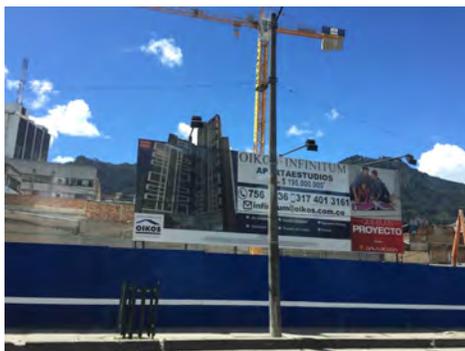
Proyecto de vivienda sobre la Caracas con Calle 57.
